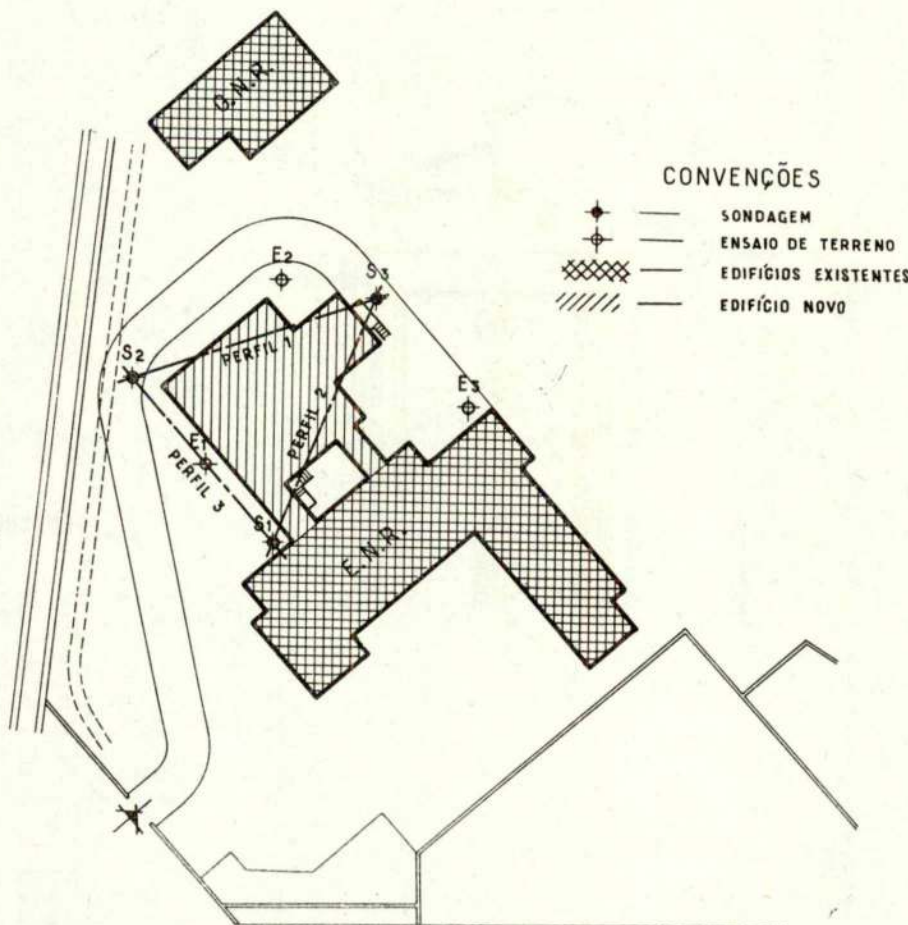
Ensaios em Castanheira do Ribatejo — Planta de localização
